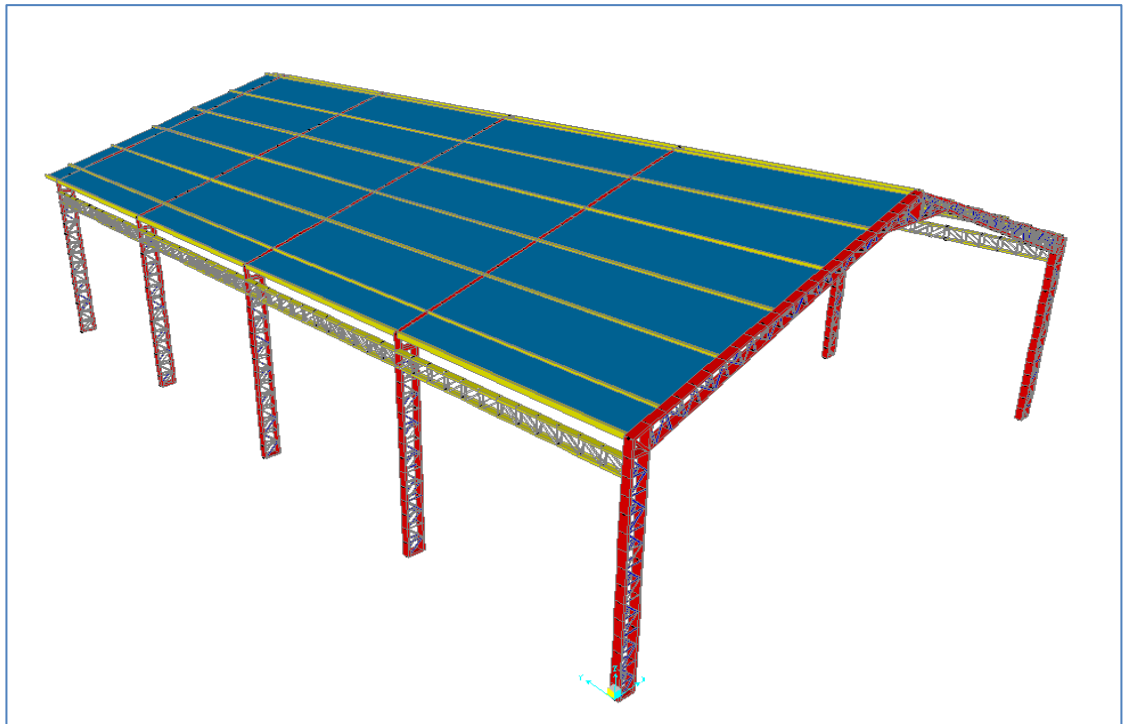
Cubierta Placa Tipo Shell e=0.35mm
